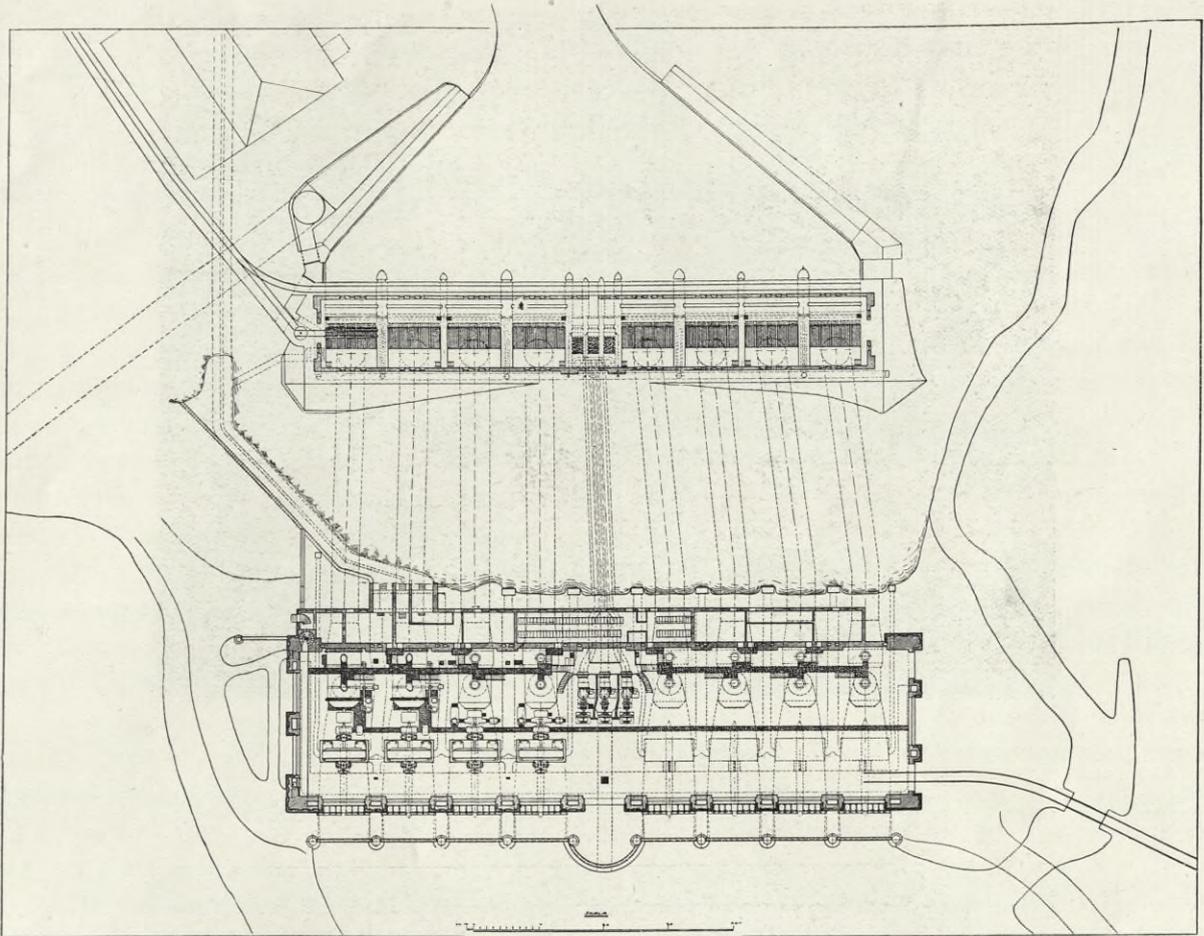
Trollhättan, Krafthaus und Wasserschloss; Grundriss.
